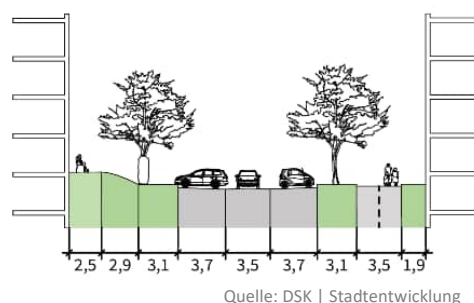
Private Wohnzimmer mit Abgrenzung zum Straßenraum durch Böschung, Schnitt A-A'
